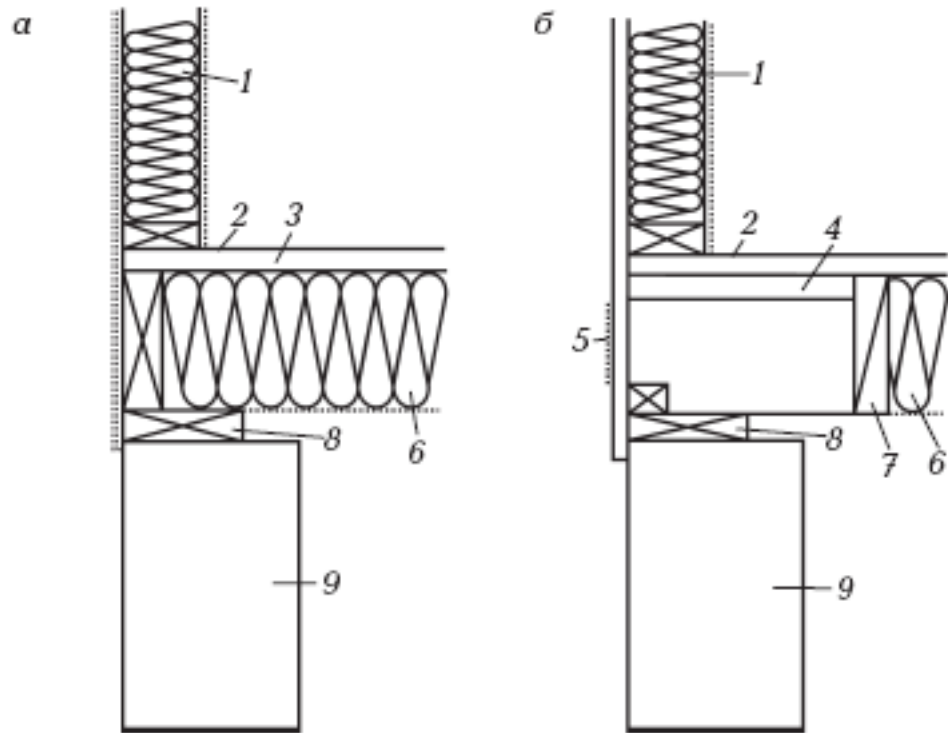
Изоляция пола у фундамента: а) укладка необлицованного мата; б) установка ограничительной распорки; 1 – каркас стены; 2 – основание чистого пола; 3 – пароизоляция; 4 – плита жесткой теплоизоляции; 5 – жалюзи в обшивке для вентиляции подвала; 6 – теплоизолирующий мат; 7 – распорка между лагами; 8 – подкладной брус; 9 – фундамент
